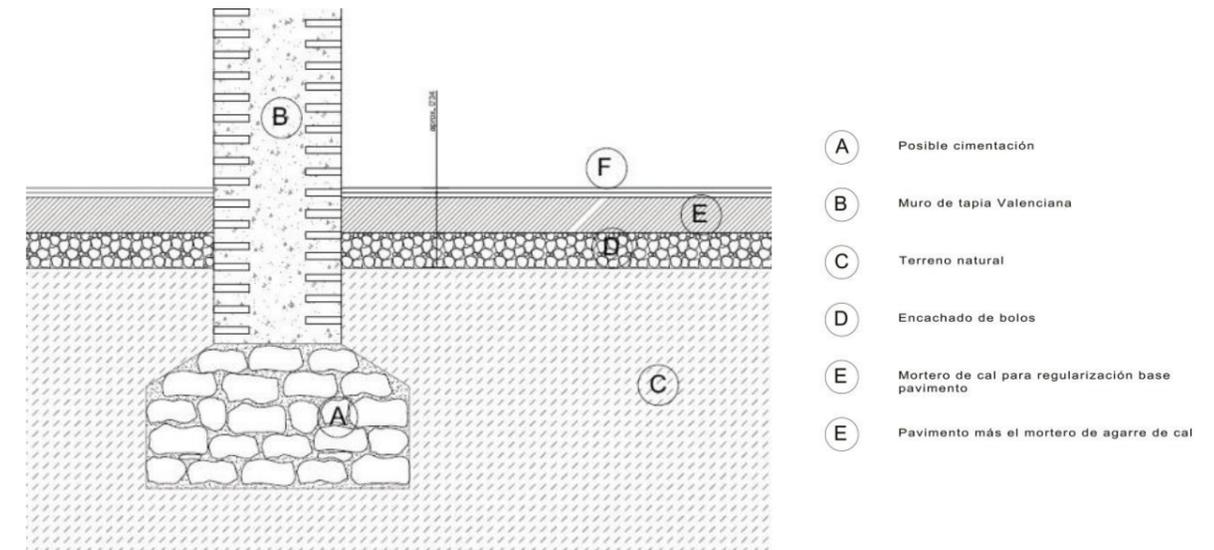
Detalle de posible cimentación Fuente: Propia
